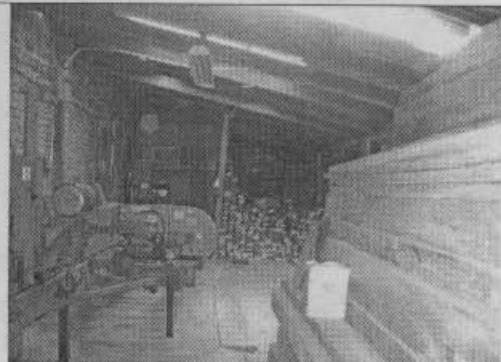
Vista interior de la fábrica, donde se aprecia la cubierta y el muro de fachada.
